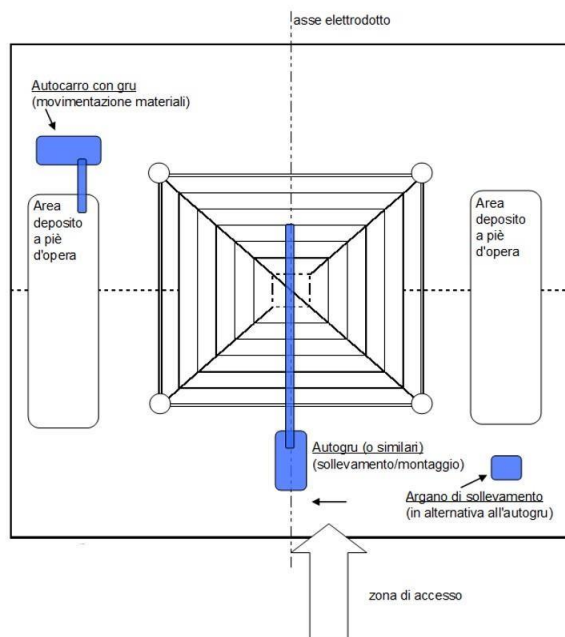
Planimetria dell'Area sostegno (montaggio sostegno) – tipologico
